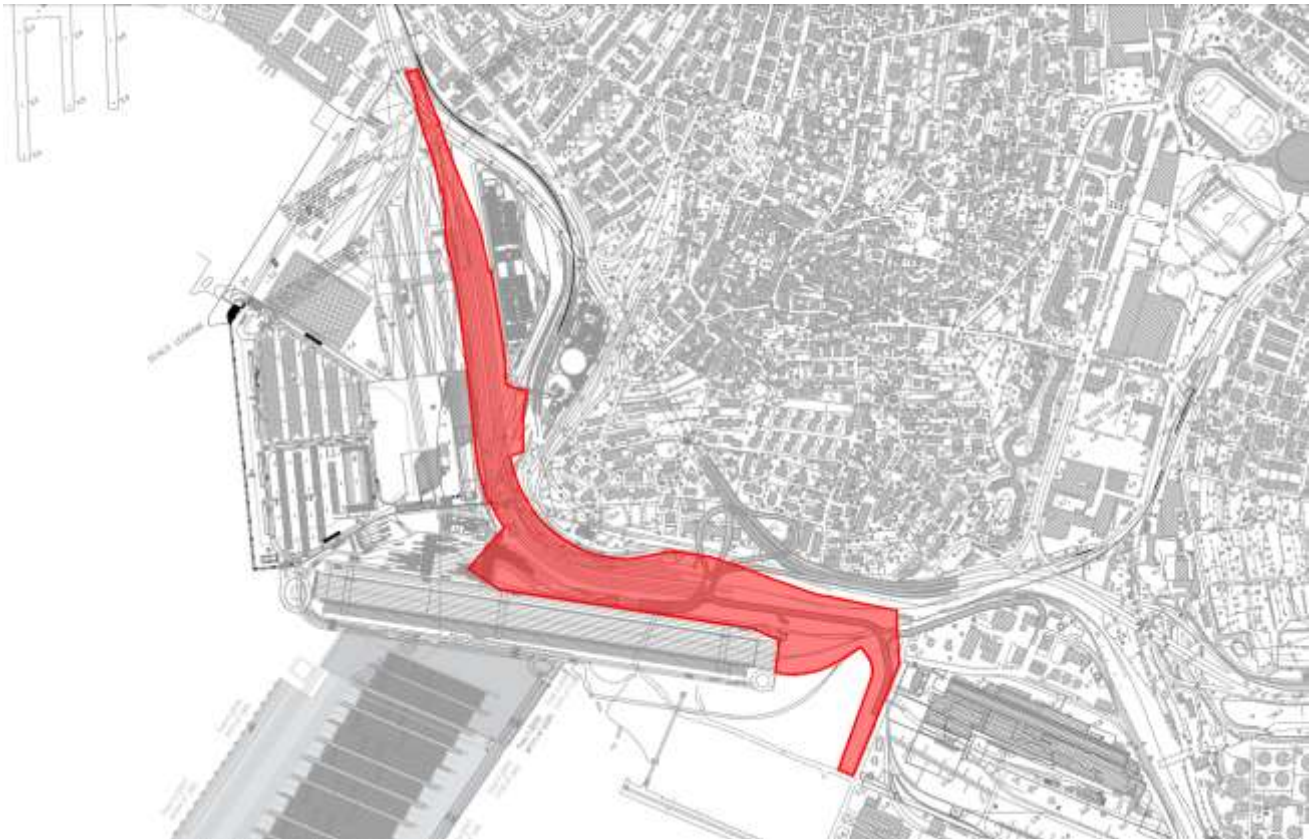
Planimetria Nuova stazione di Servola (2FER)
